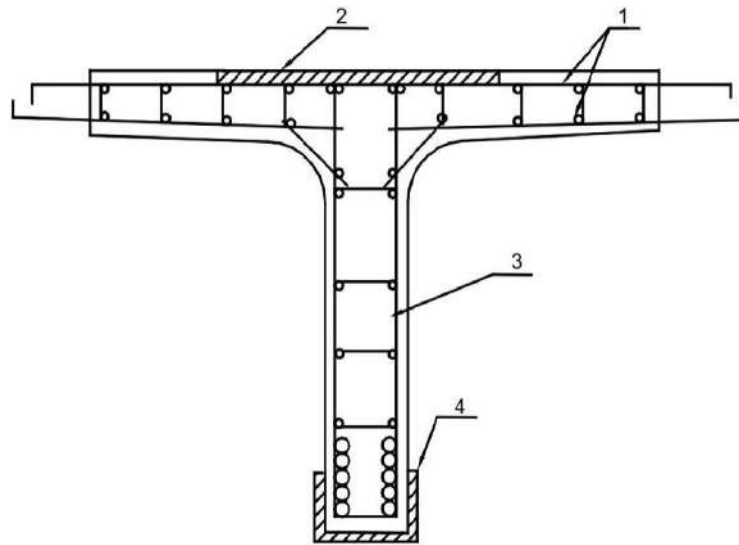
Усиление железобетонной балки приваркой плоского листа к плите и обоймы из швеллера к ребру: 1 – существующая арматура; 2 – лист усиления; 3 – усиливаемая балка; 4 – швеллер (обойма)
